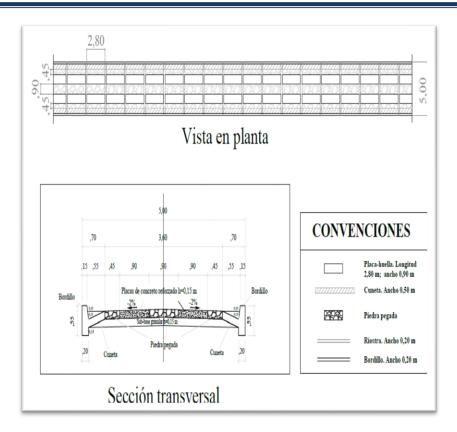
Vista en planta y transversal de la placa huella Fuente: Diseño de pavimento para placa huella
